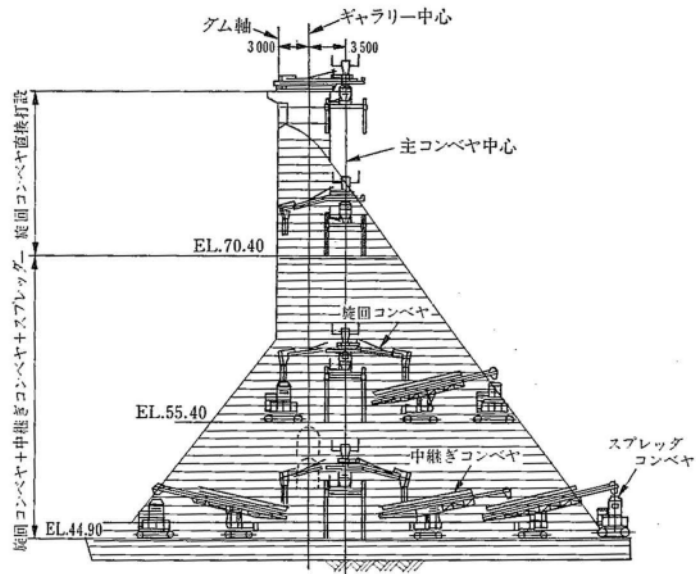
3 - 12 BCP 工法におけるコンベヤ配置図 (小平ダム)
